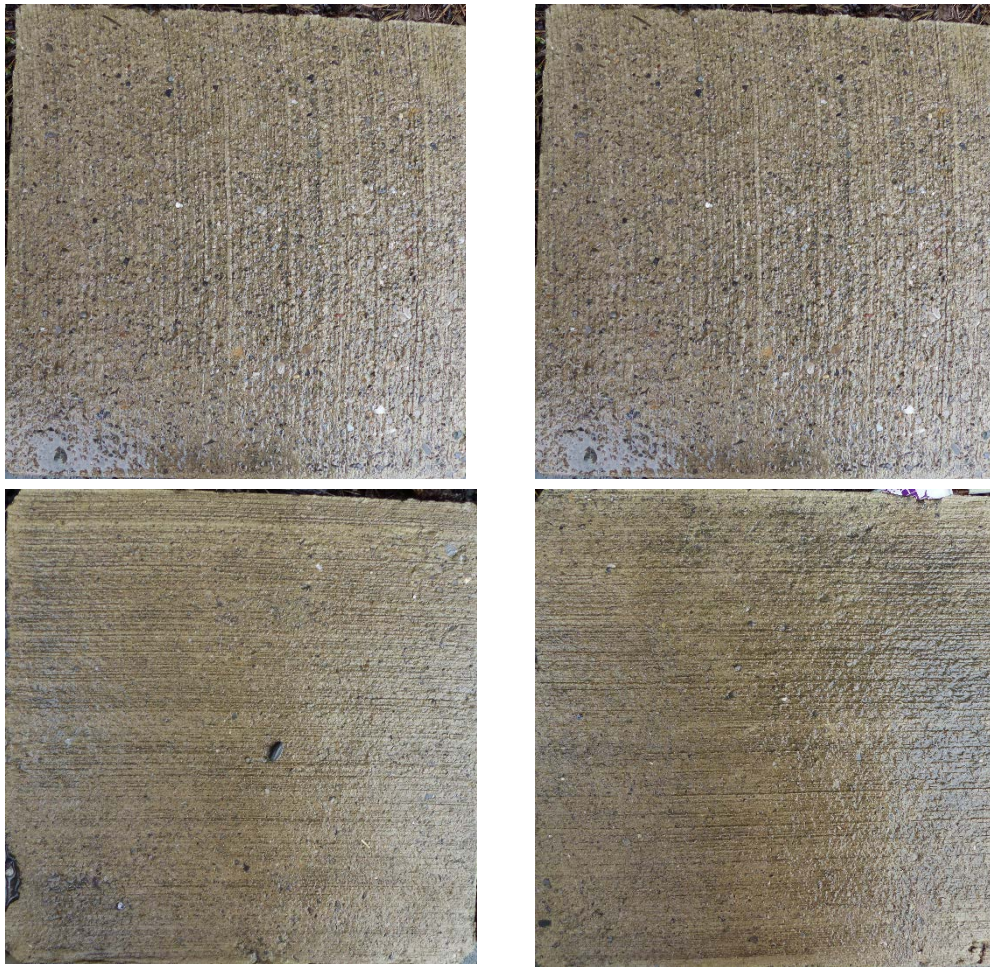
Zustand der Versuchsplatten der Betone mit CEM III/B und einem w/z-Wert von 0.45 am 14.05.2014. Oben: Beton 9 ohne LP. Unten: Beton 10 mit LP (jeweils linke und rechte Platte, Blickrichtung Südwesten).
